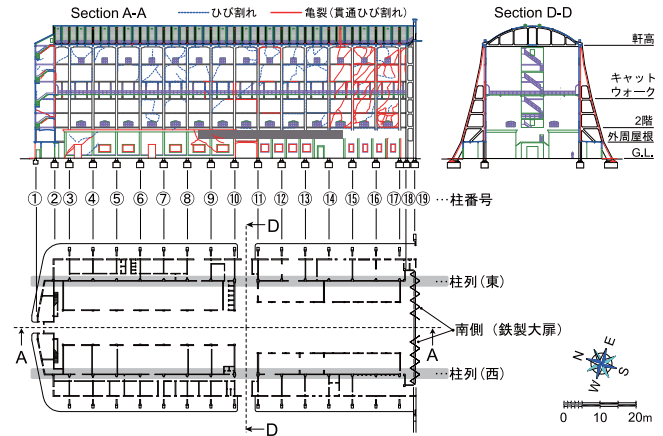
断面図・平面図・柱番号割付・ひび割れ状況概要
